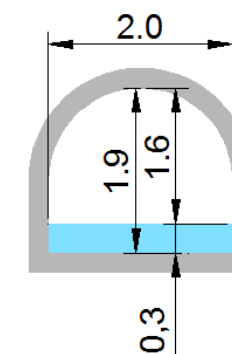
Profil en travers de l'ouvrage hydraulique de La Vilette (source : SEGIC)
